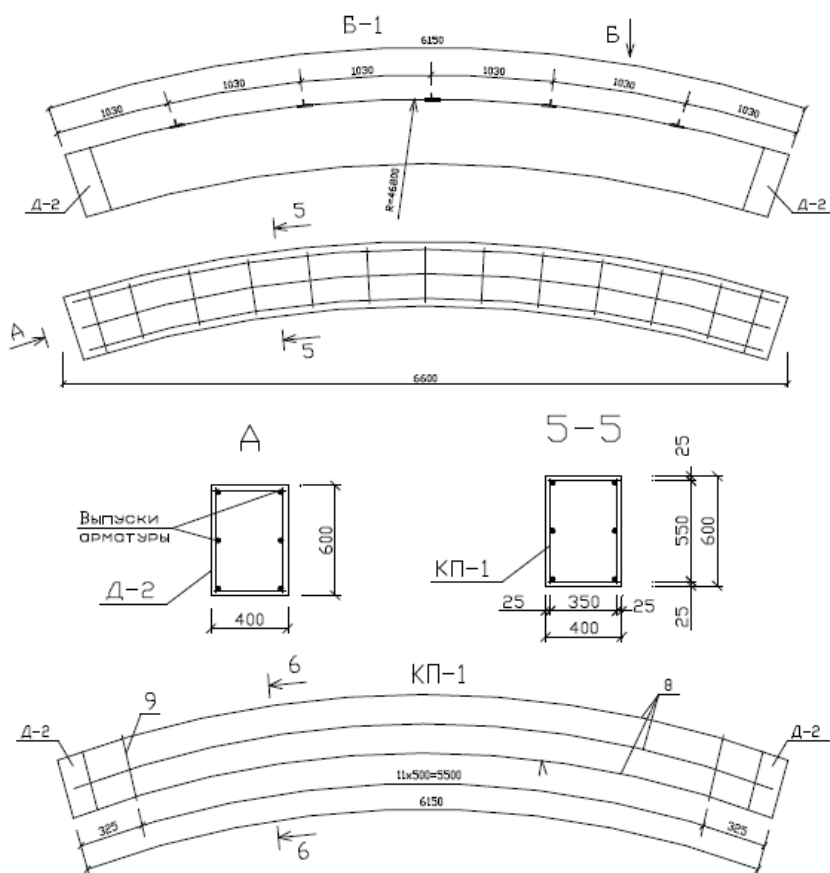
Балка опорного контуру Б-1, схема армування, каркас КП-1
